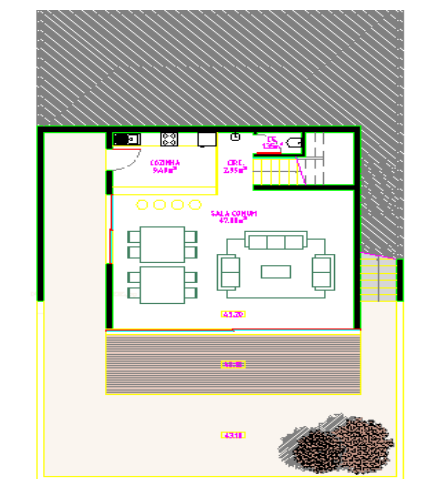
Planta do piso -1, moradia da Ajuda
